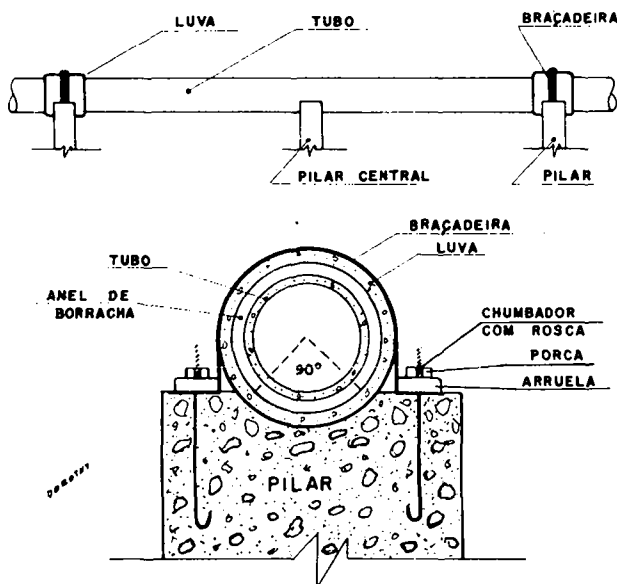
FIXAÇÃO DAS LUVAS COM BRAÇADEIRAS (58*)
